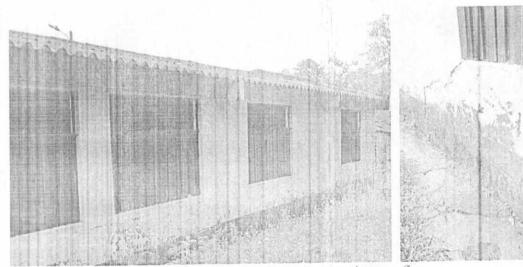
y 15 Muros fachada posterior con fisuras.
